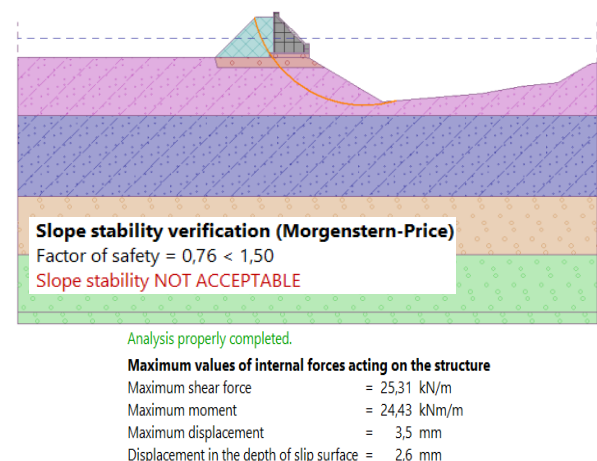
Gaya Internal dan Kinerja Struktur Cross Section P7
